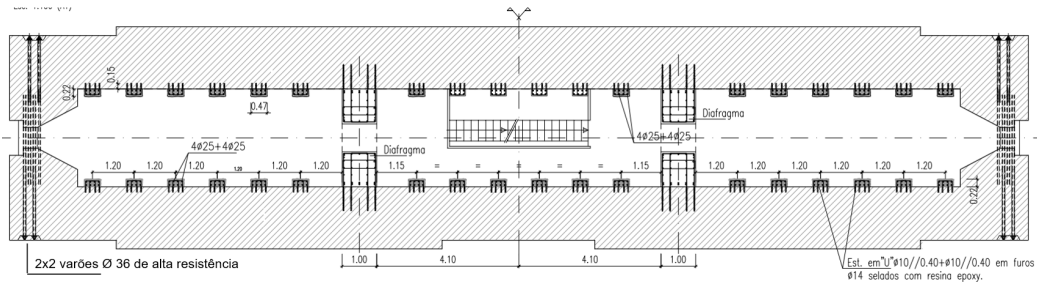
Reforço das pilastras com nervuras armadas, reforço de lintéis e paredes-diafragma.
